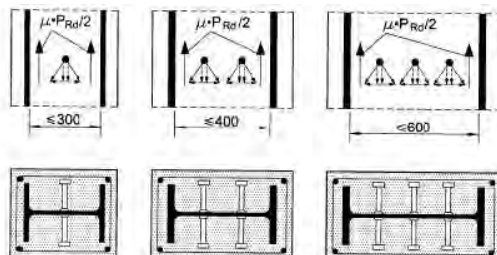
Disposizione dei pioli per la connessione meccanica acciaio-calcestruzzo
